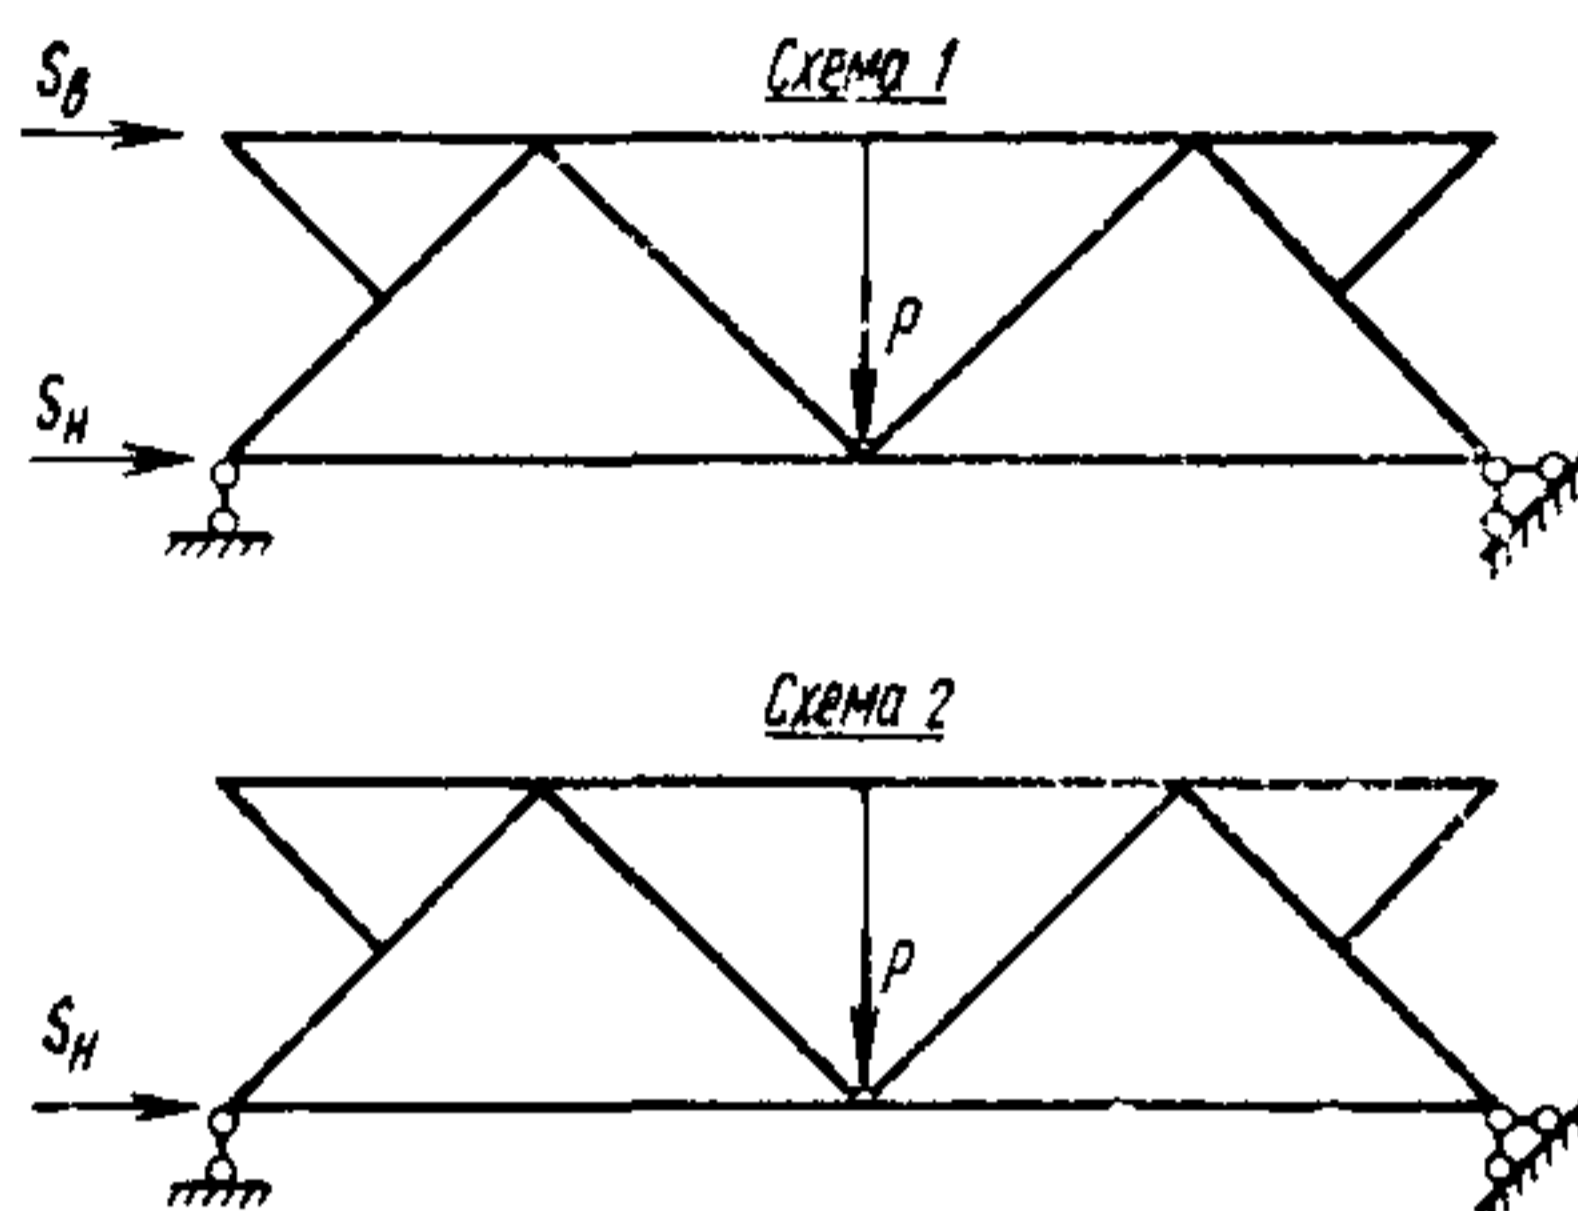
Расчетные схемы подстропильных ферм покрытий из стального профилированного настила
